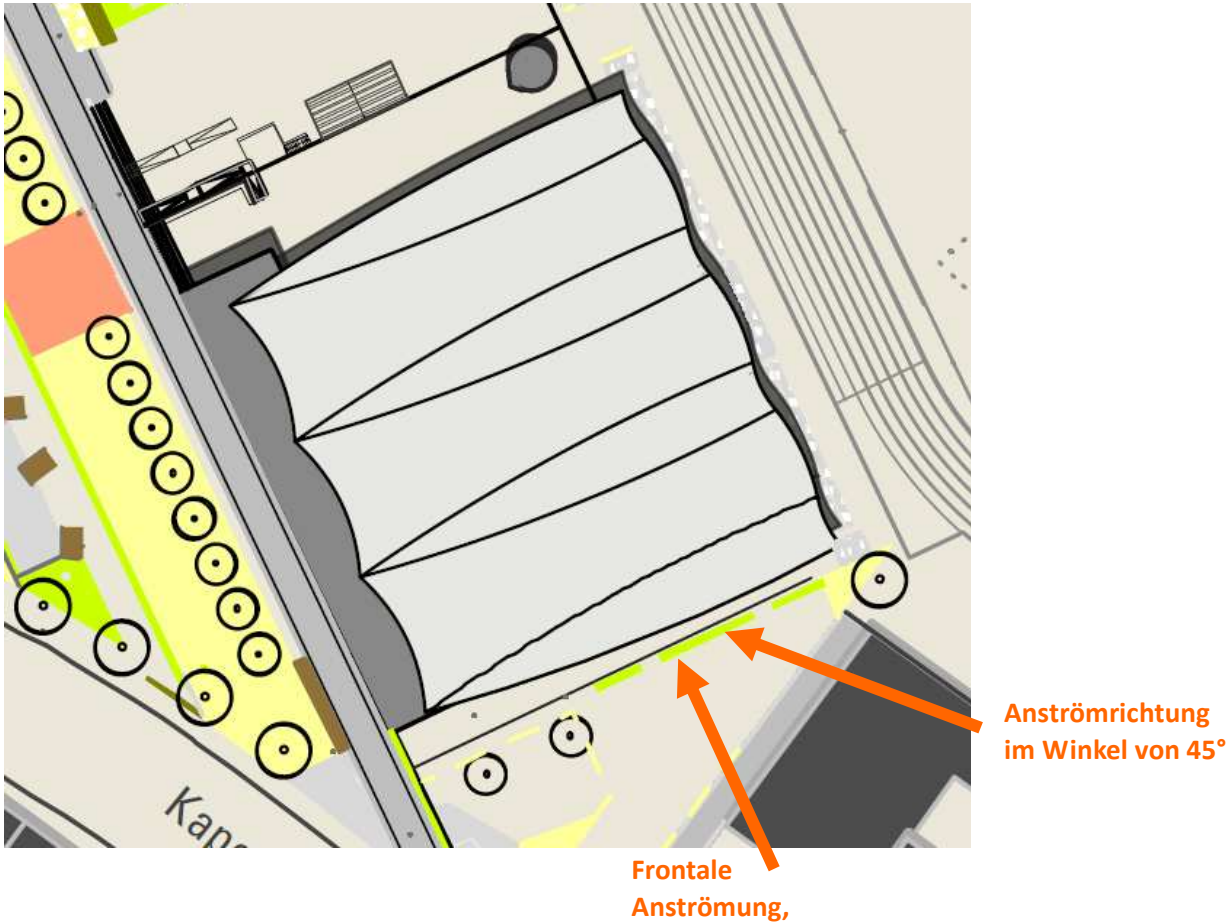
Ausschnitt aus Lageplan der Sporthalle
